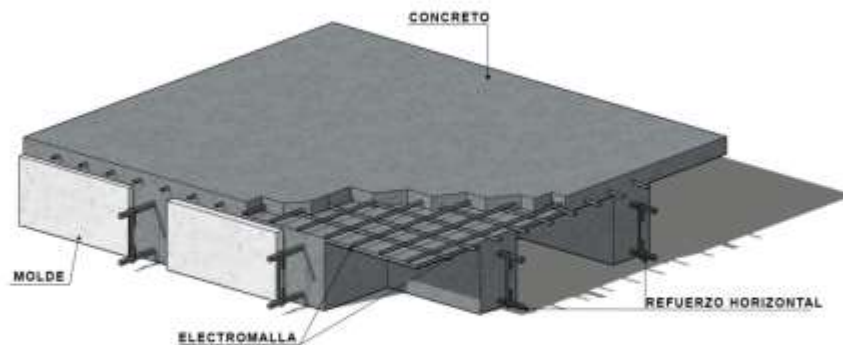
LOSA RETICULAR APOYADA SOBRE VIGAS EN DOS DIRECCIONES
